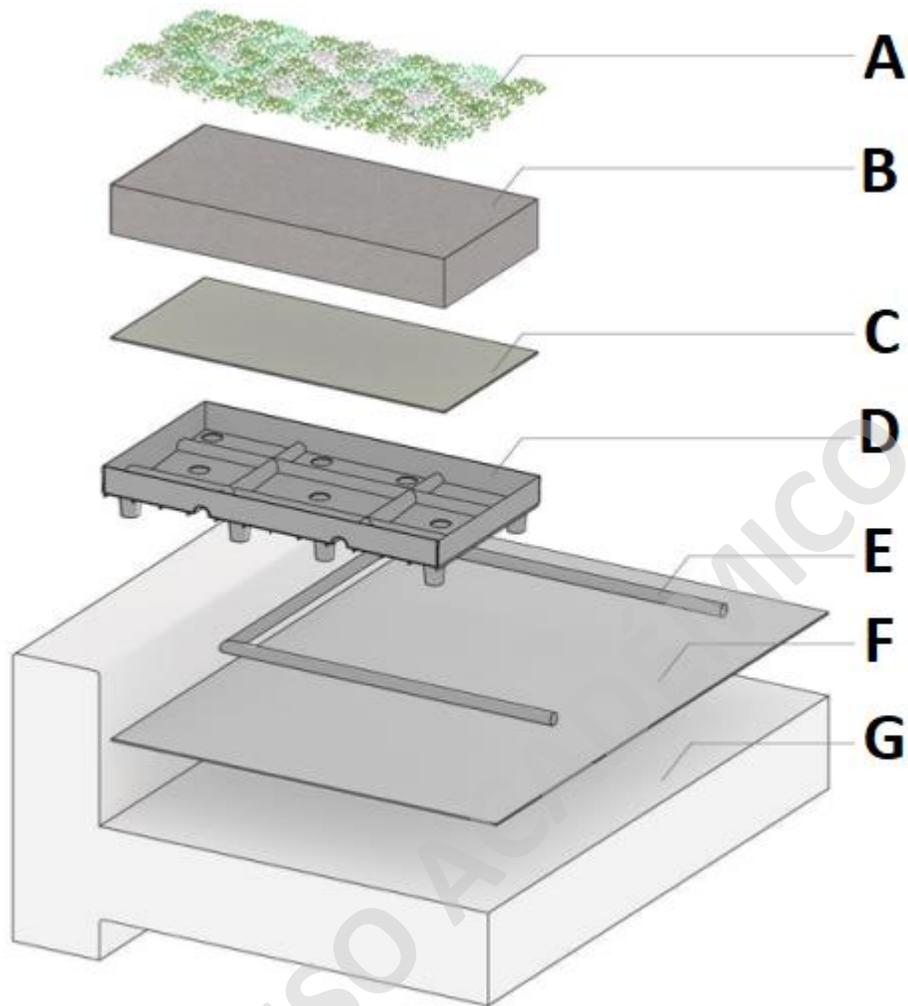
Componentes aplican para cubierta intensiva/extensiva.
